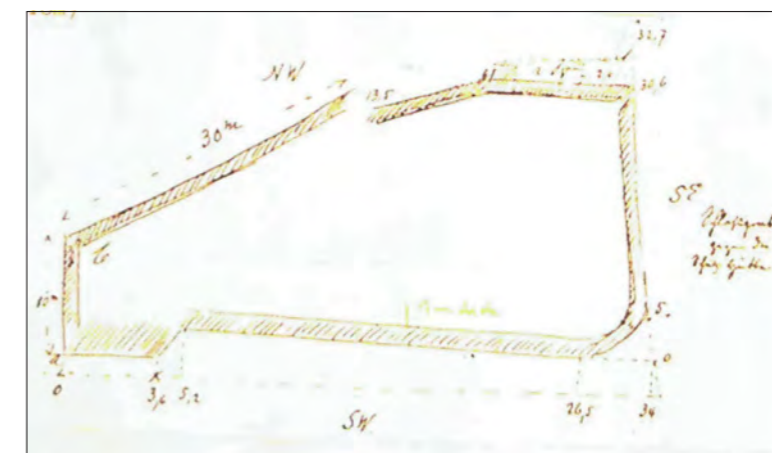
Grundriss Grabung Pletscher, 1896
